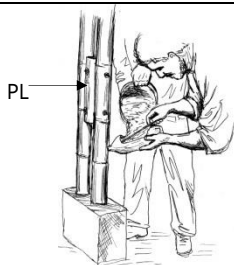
e Fig. 38 – Ligação e preenchimento dos pilares com argamassa
